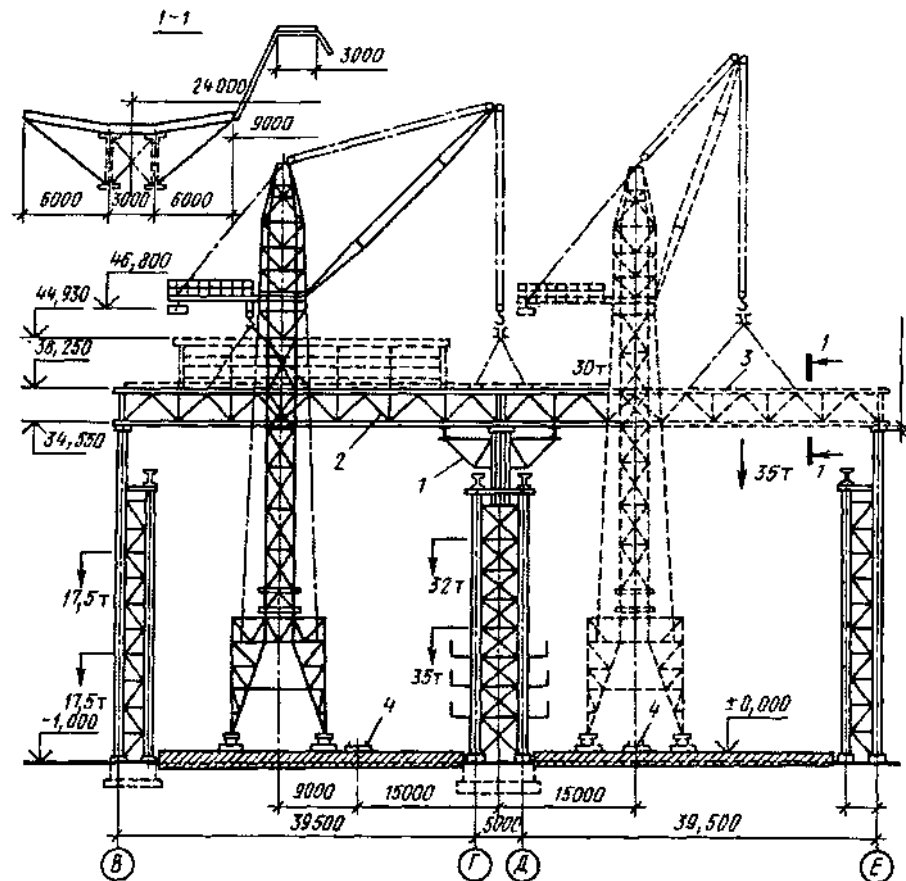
Приклад схеми монтажу покриття елінгу за допомогою тимчасової монтажної опори: 1 - тимчасова монтажна опора з консолями; 2 - частина елемента ригеля в прольоті В-Г; 3 - друга частина ригеля в прольоті Д-Е із замиканням у нерозрізну балкову систему; 4- шлях подачі укрупнених монтажних елементів
